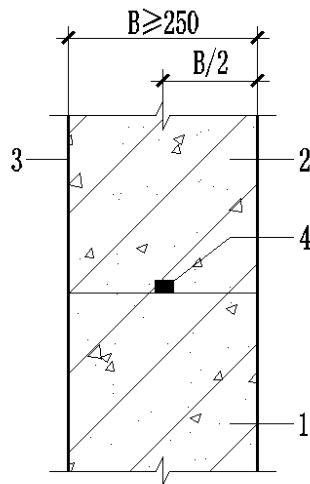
施工缝遇水膨胀止水条防水构造
